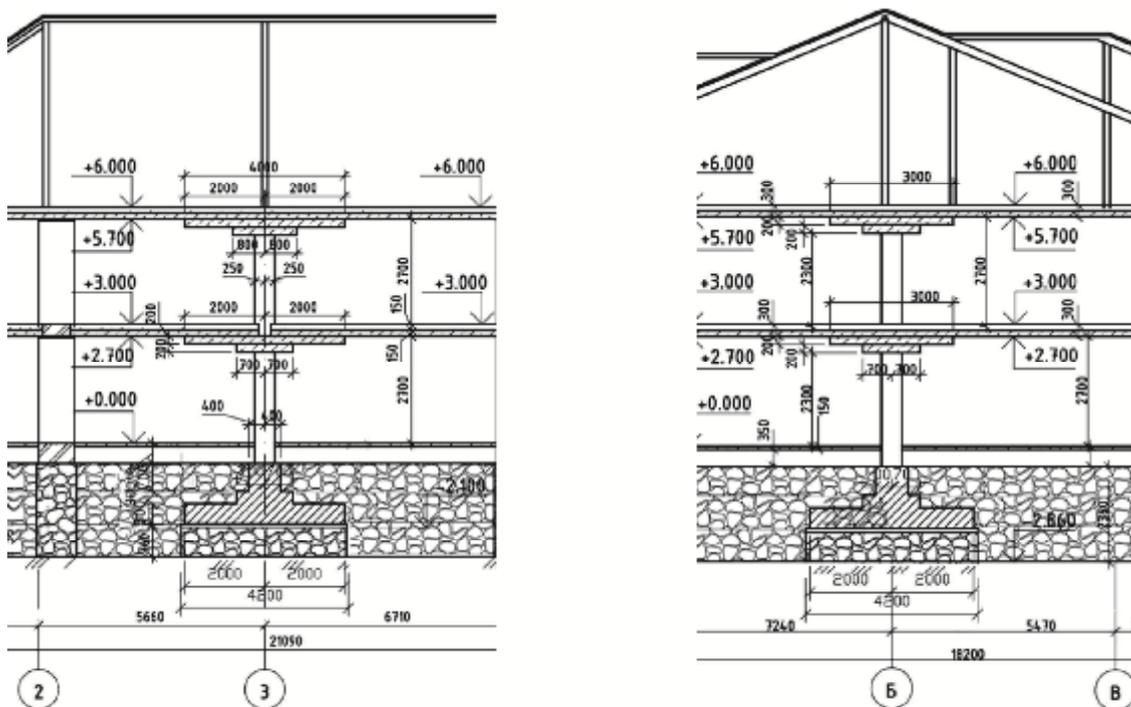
Разрезы по конструкциям центральной колонны на столбчатом фундаменте (иллюстрация авторов)
